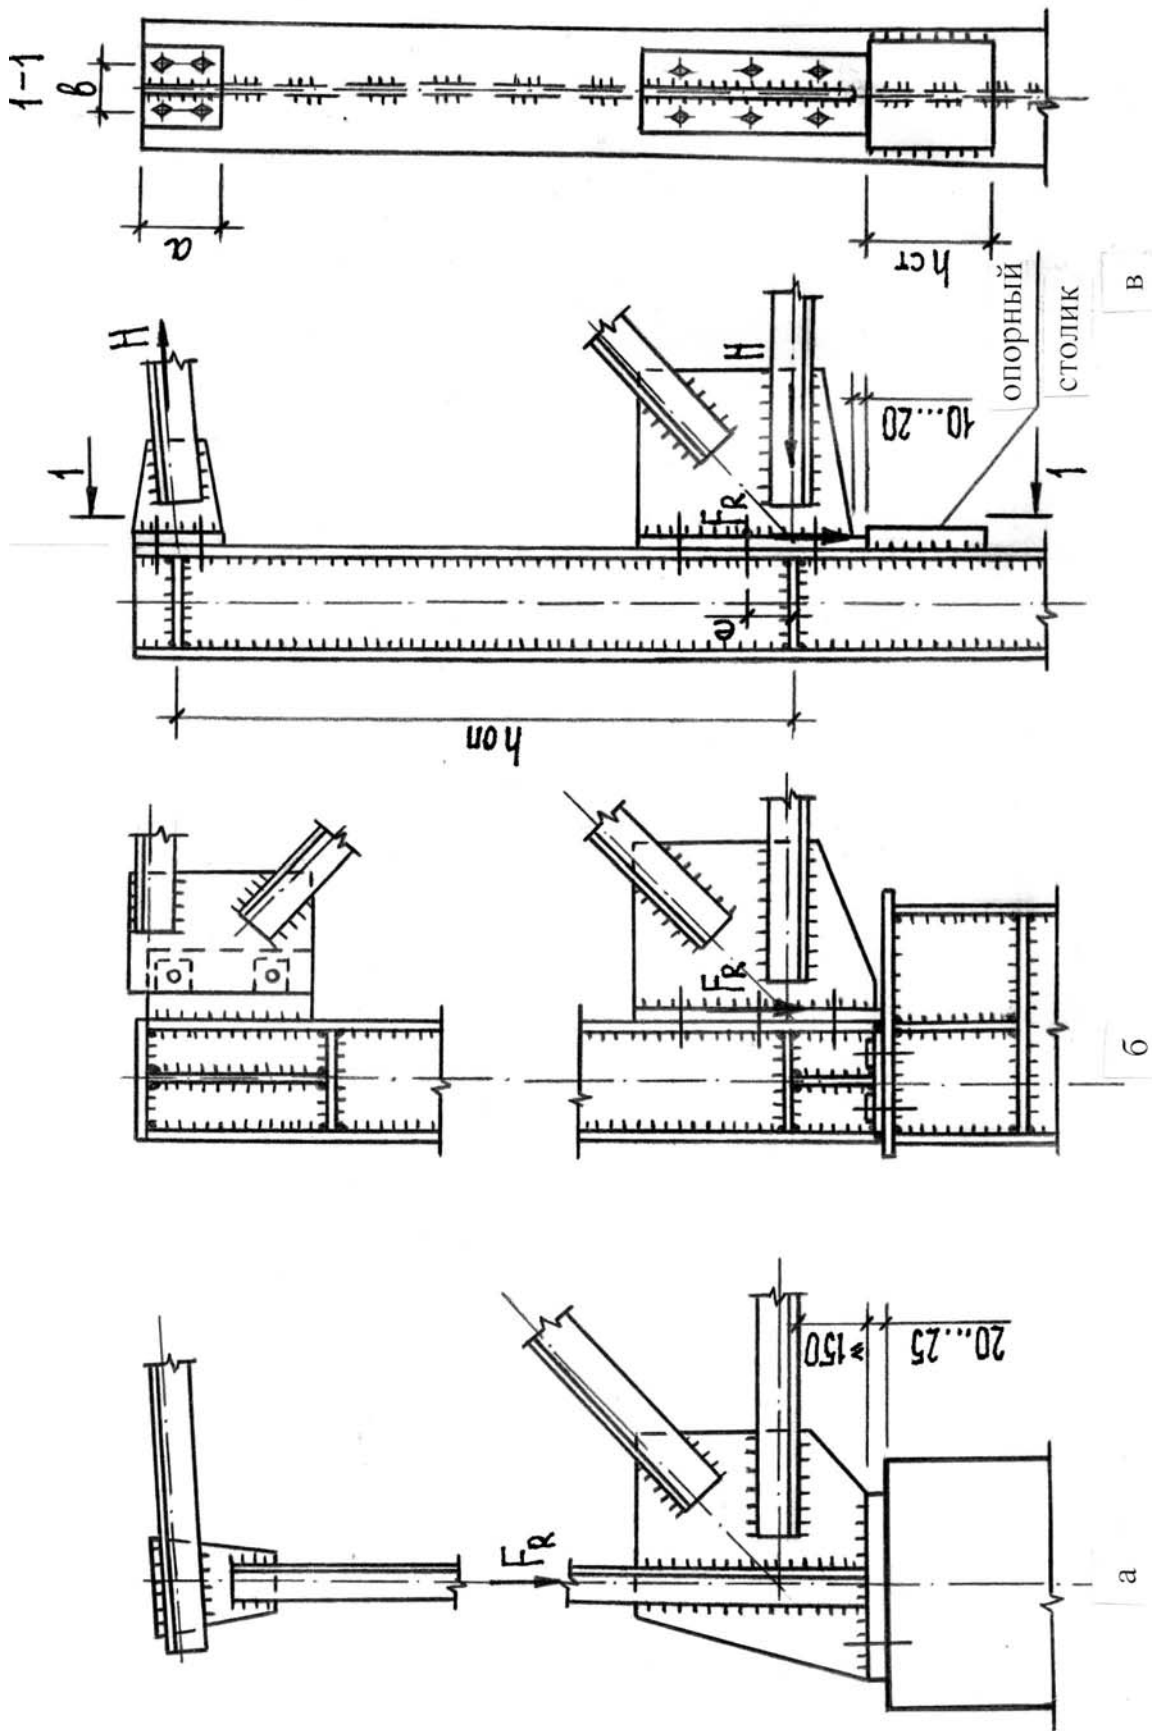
Опорные узлы ферм: а – свободное опирание; б – опирание фермы на колонну сверху; в – примыкание фермы к колонне сбоку
